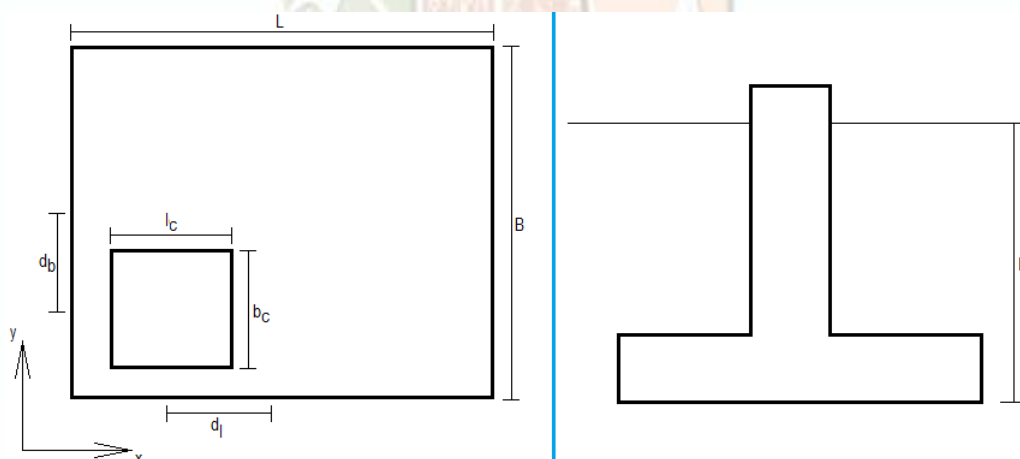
Parámetros de Diseño Geométrico para las Zapatas
